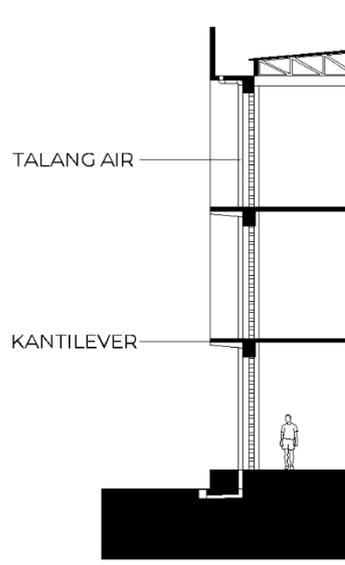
Sistem Struktur & Konstruksi Atap Bangunan
